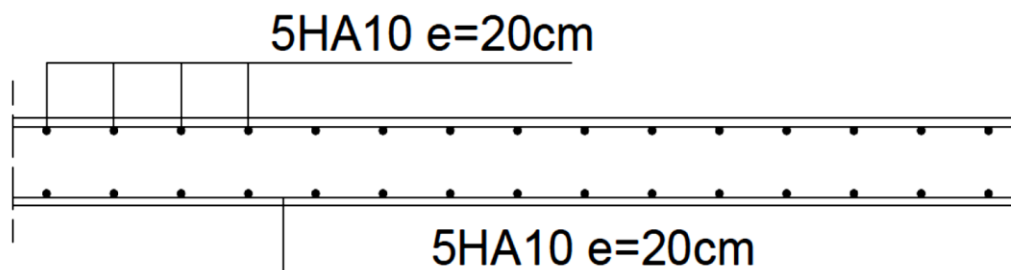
Schéma de ferrailage de la dalle machine d'asc
